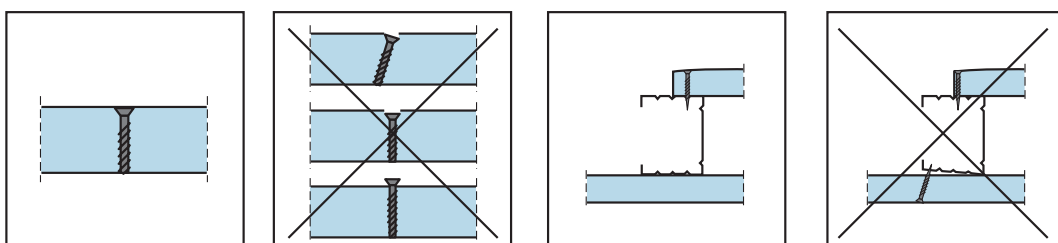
Схема расположения шурупов при двухслойной облицовке ГКЛ
